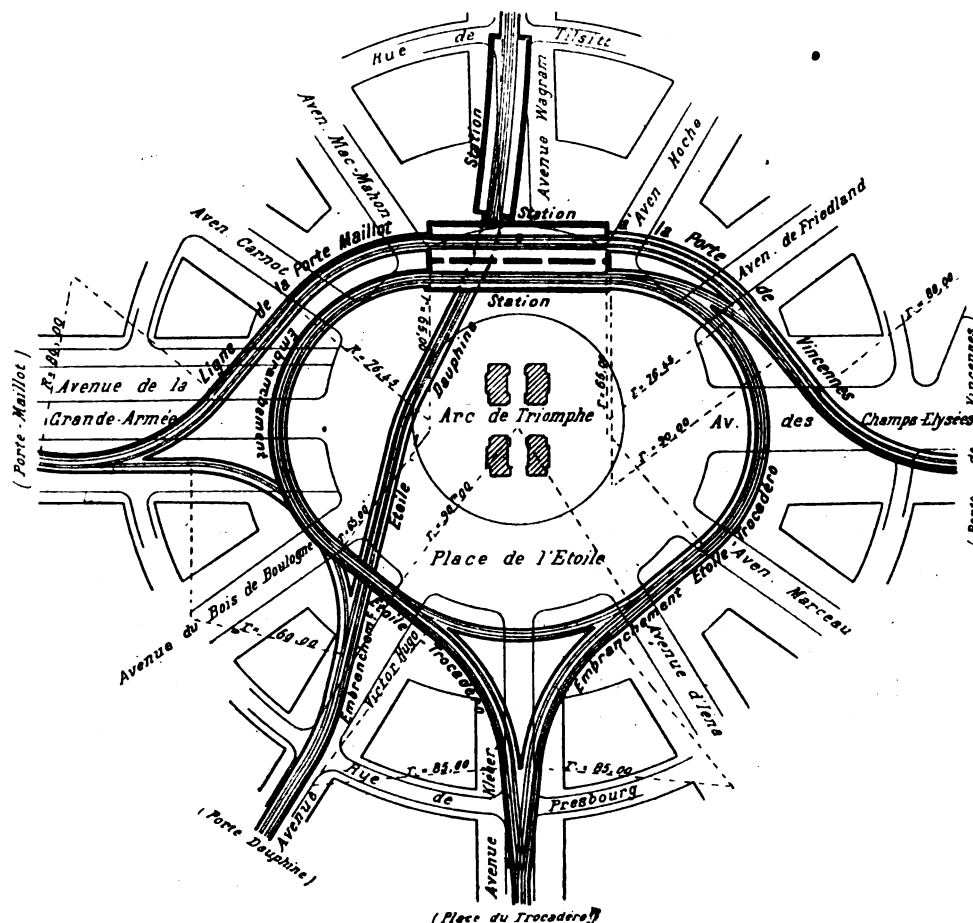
Plan des voies et des stations sous la place de l'Étoile.
